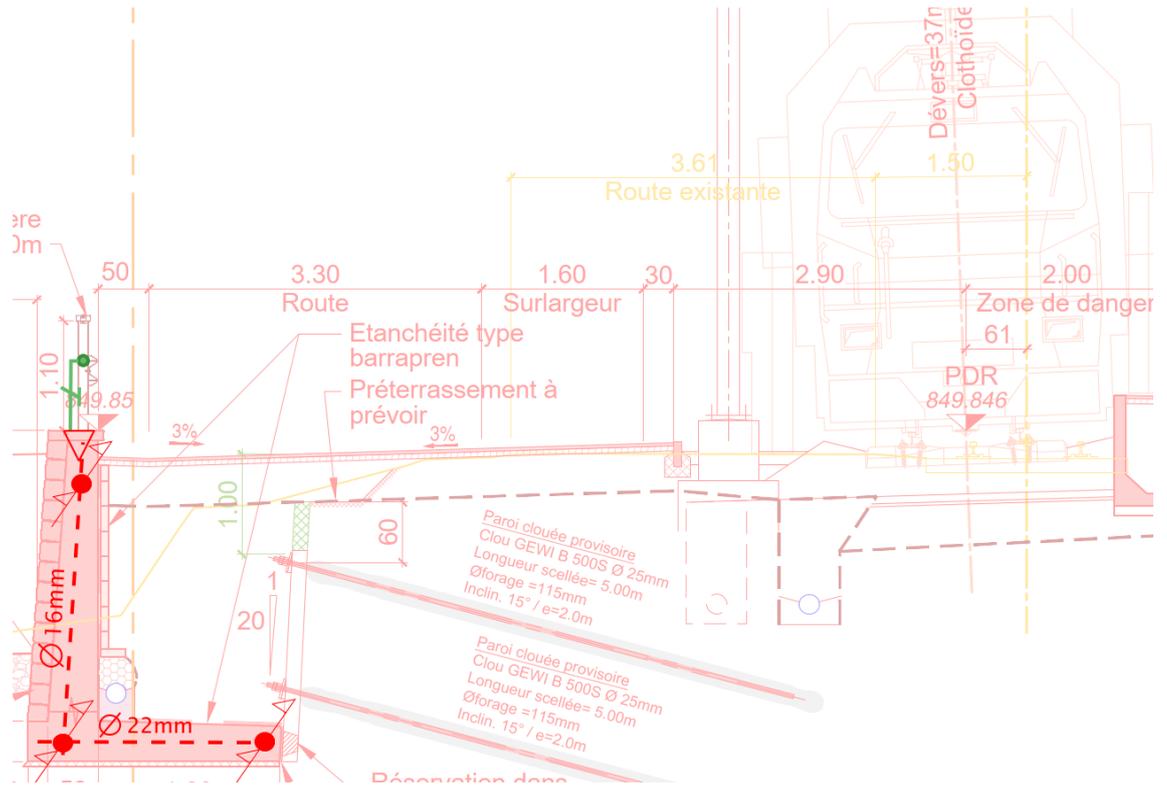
Barres collectrices le long du mur de soutènement (source: pièce 12.2.7 du dossier PAP).
